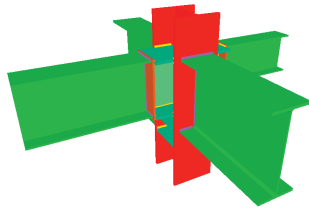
Unione saldata di due travi incastrate all'anima del pilastro e di due travi alle ali (pilastro passante)
